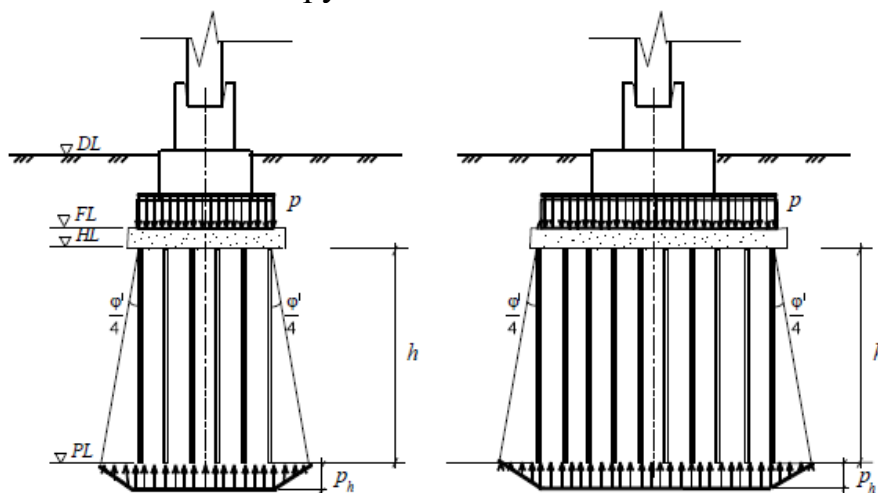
Расчетная схема армированного поля ограниченных размеров: p – среднее давление по подошве фундамента (FL); p_h – среднее давление в уровне нижнего конца армоэлементов (PL); $\bar{\varphi}$ – средневзвешенное значение угла внутреннего трения грунтов, залегающих в пределах длины армоэлементов h
